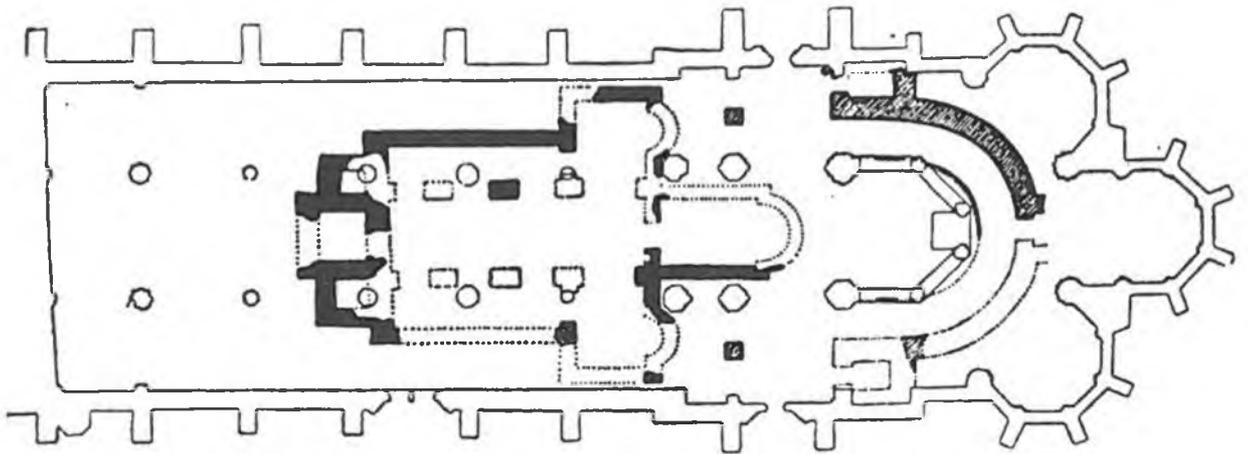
Linköping, Dom, Grundriß mit ergrabenen Vorgängerbauten
